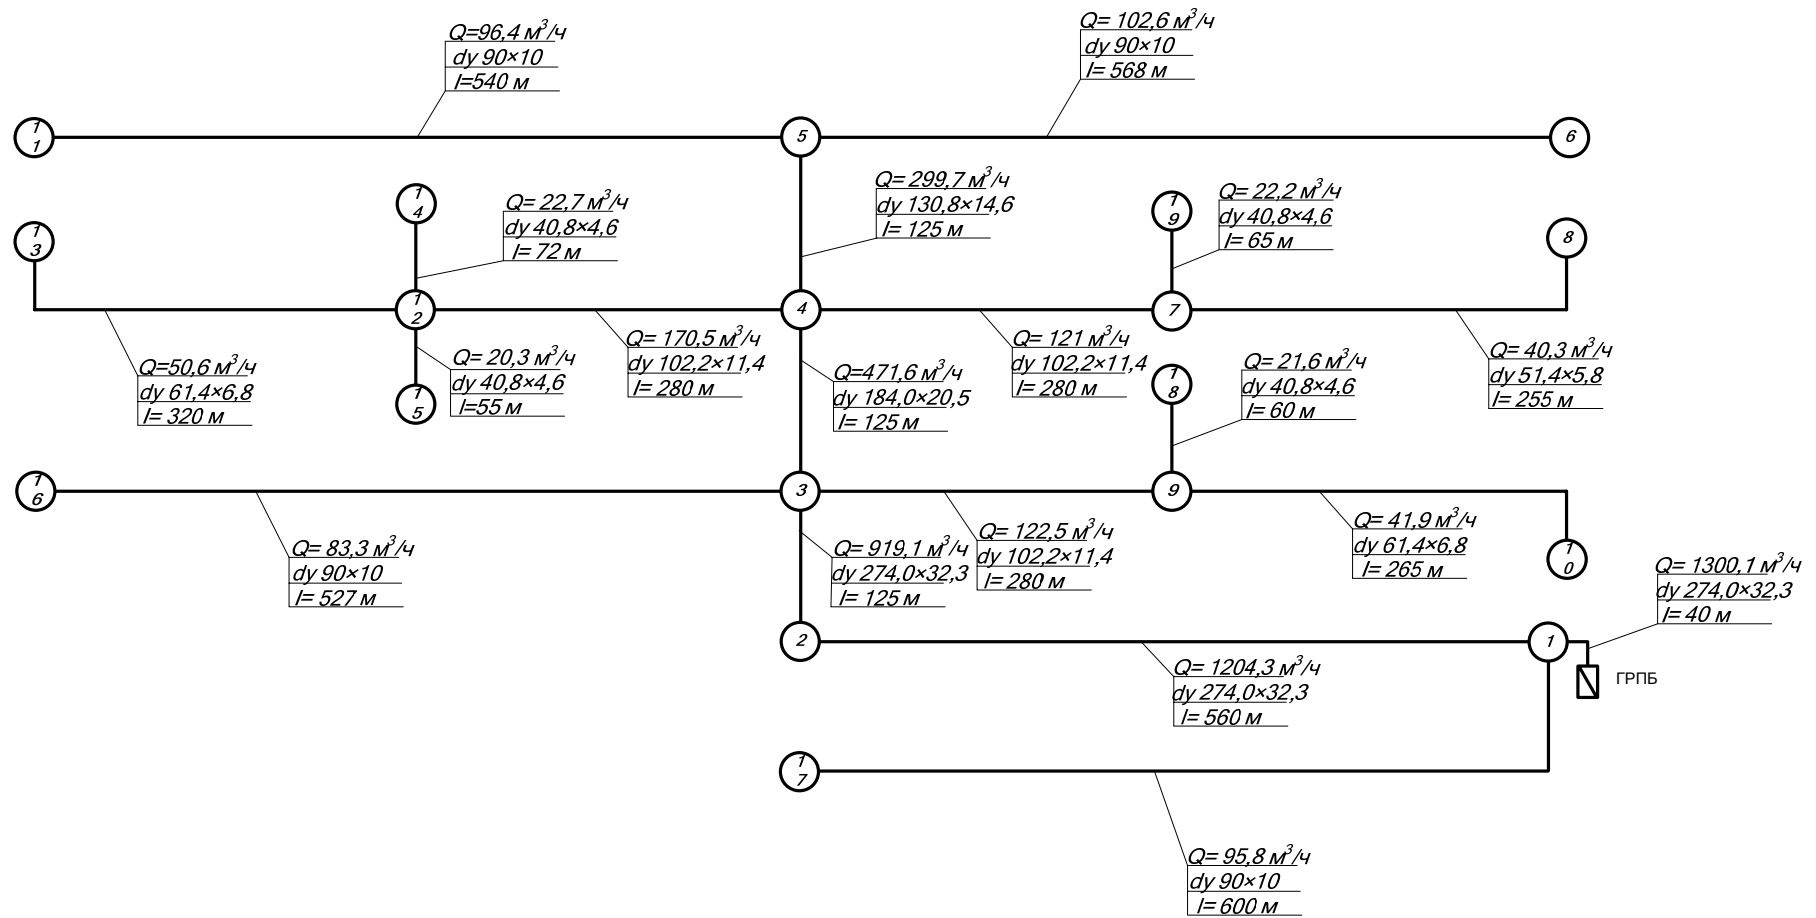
Расчетная схема газопроводов низкого давления поселка
